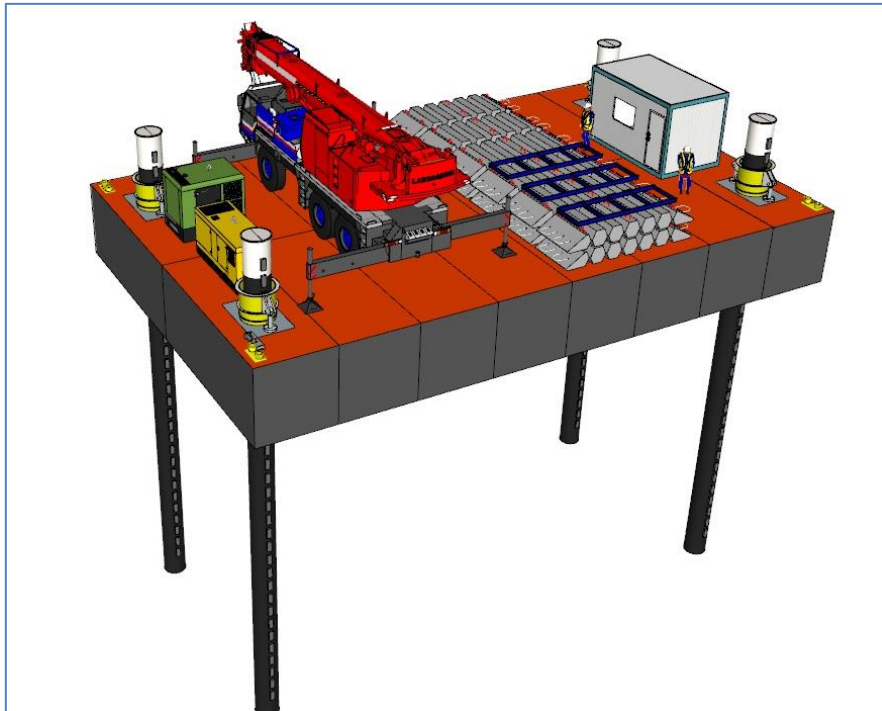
Disposición prevista de pontona TEMS III con la grúa de 55 Tn. embarcada.
